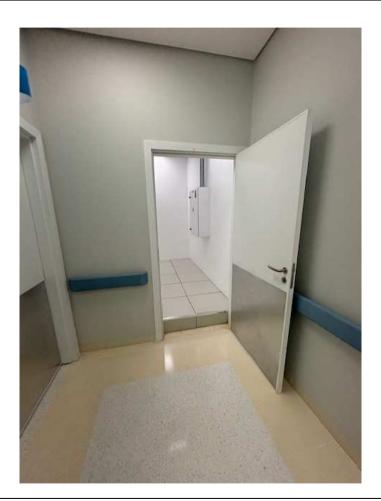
Detalhe da porta de acesso da sala de exames e piso elevado deverá ser removido e providenciar piso cerâmico ou vinilico para acabamento.
